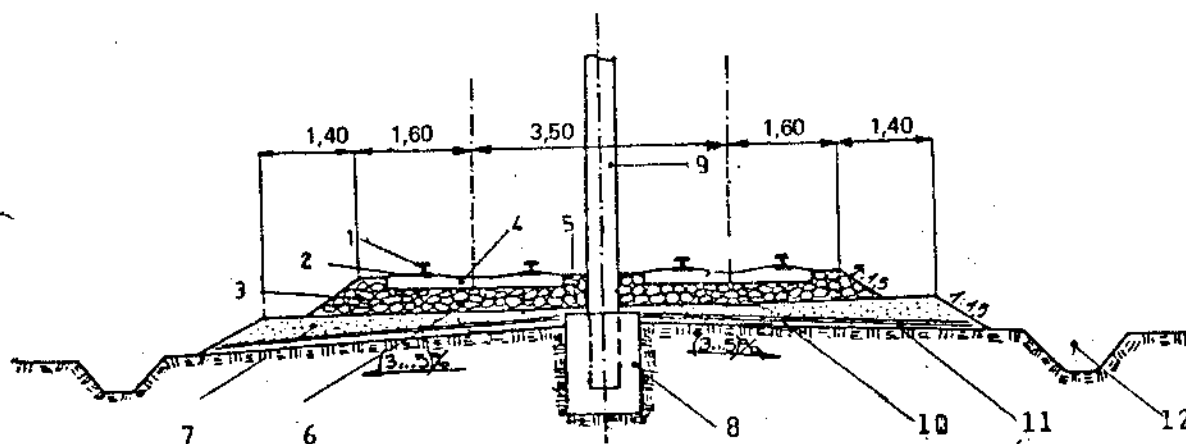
Profil transversal pentru calea de rulare dublă, cu șină de tramvai, pe traverse, închisă cu plăci de beton prefabricate, cu dren central
